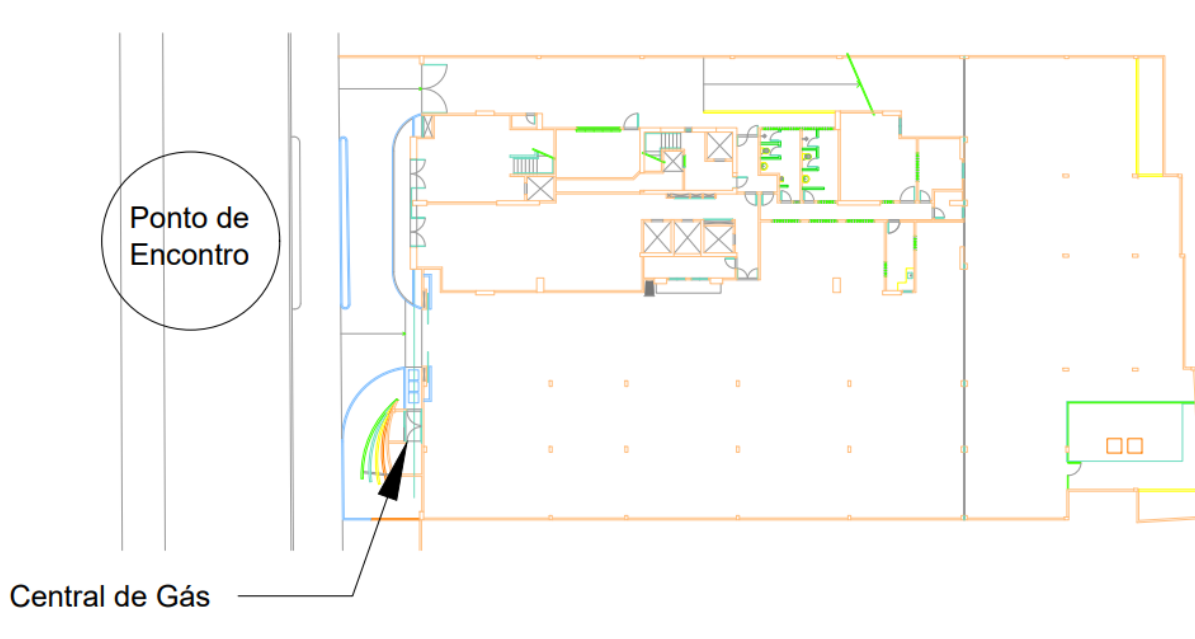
Planta de rota de fuga para o pavimento tipo do edifício B
